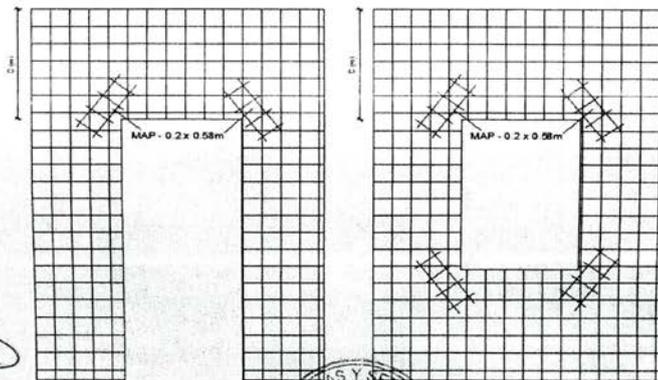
Refuerzo de Dinteles con armadura longitudinal
